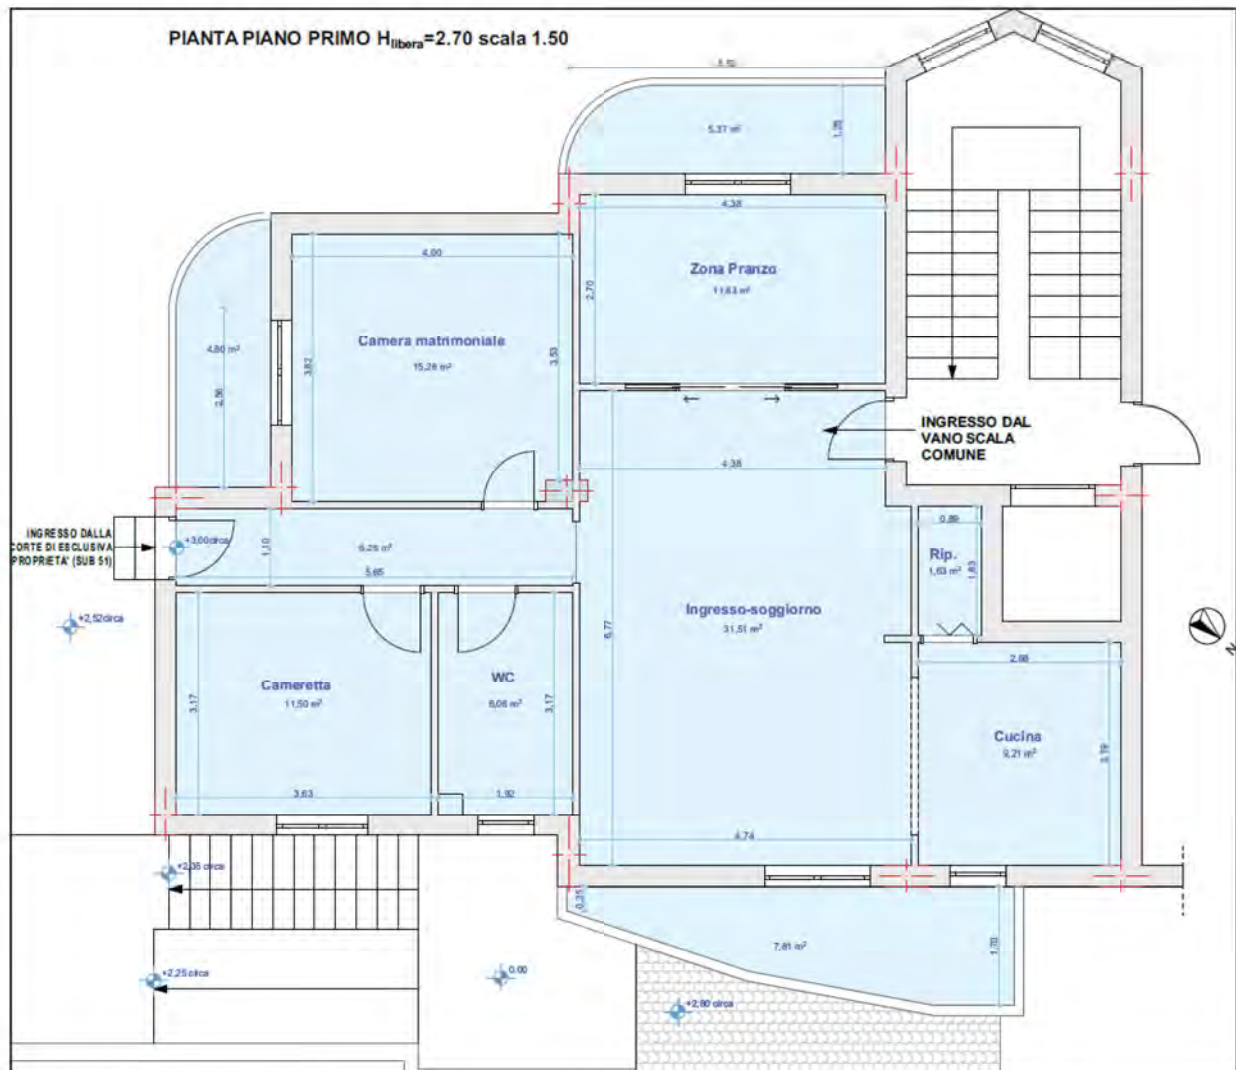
Rilievo metrico dell'appartamento oggetto di pignoramento con indicazione delle superfici nette – piano primo.
